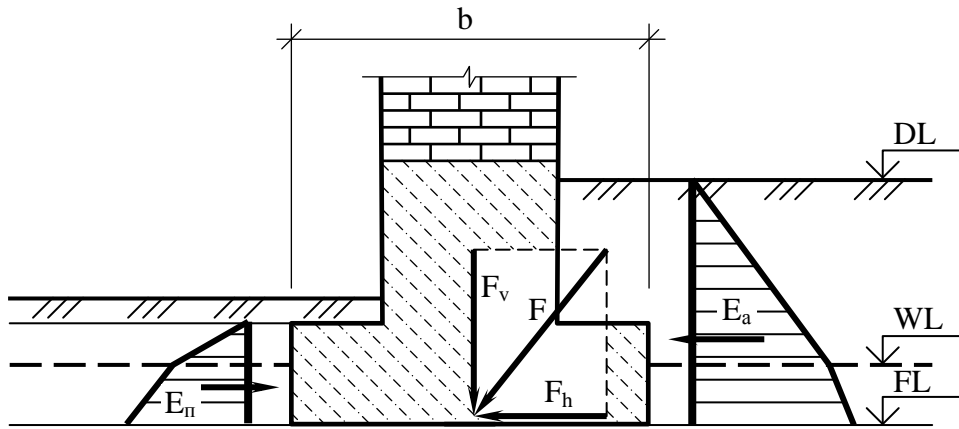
До розрахунку фундаменту на плоске зрушення
